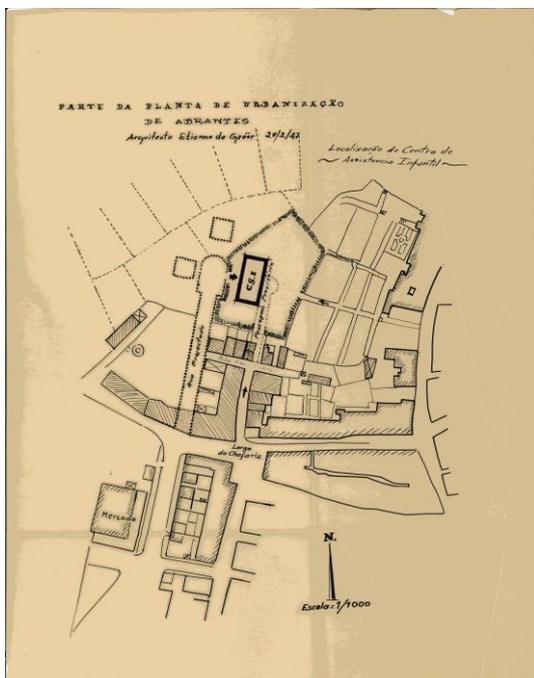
Planta de localização do Centro de Assistência Infantil.
